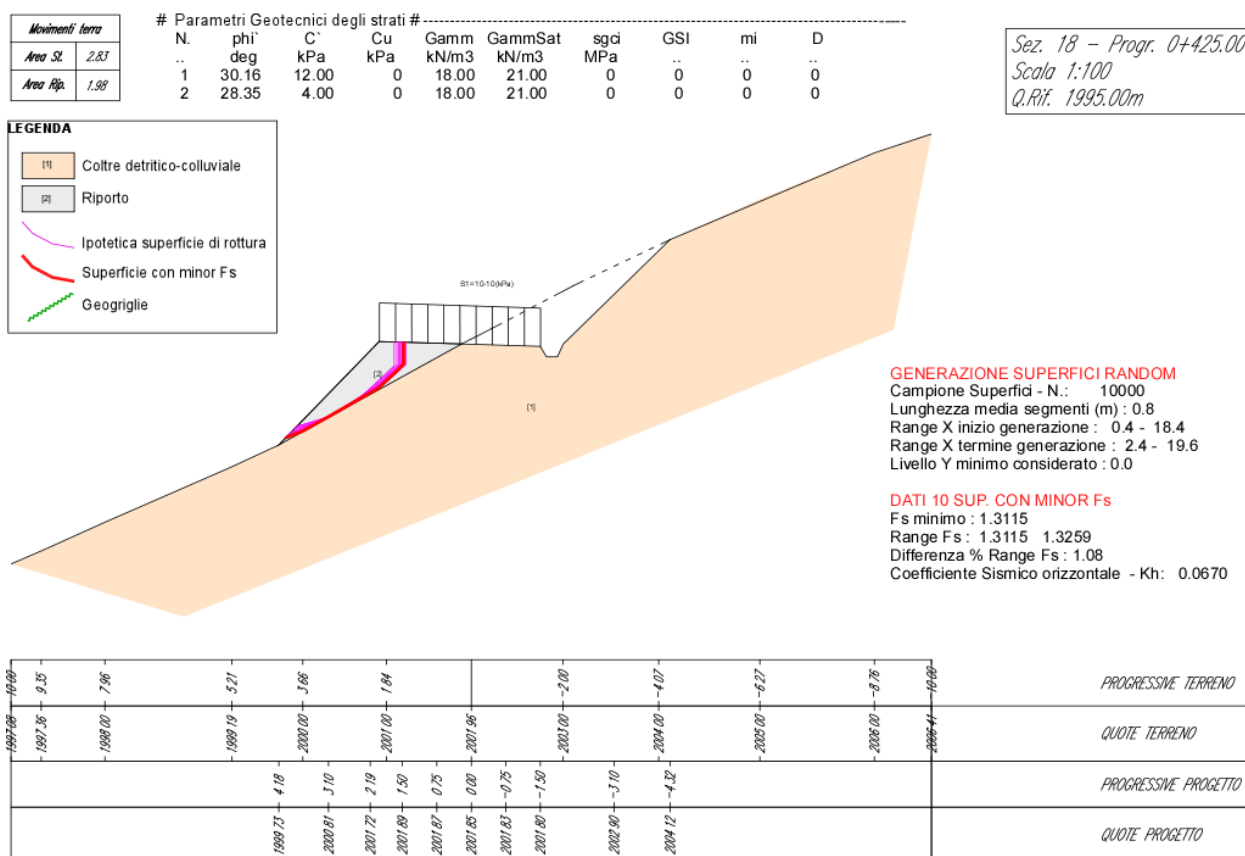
Sezione geologica schematica e verifiche di stabilità lungo la sezione 18.
